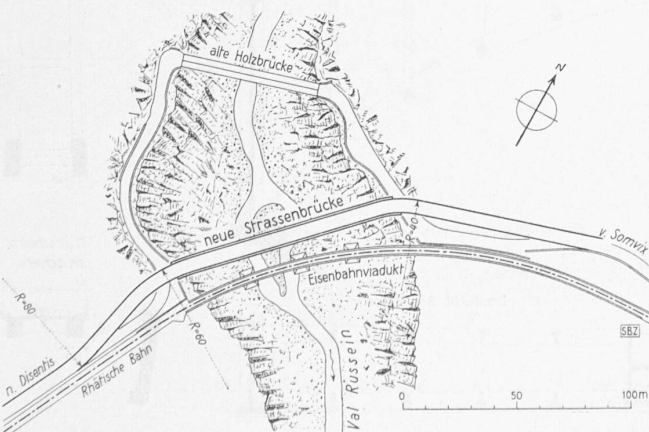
Lageplan der drei Russeintobel-Brücken 1 : 3000
